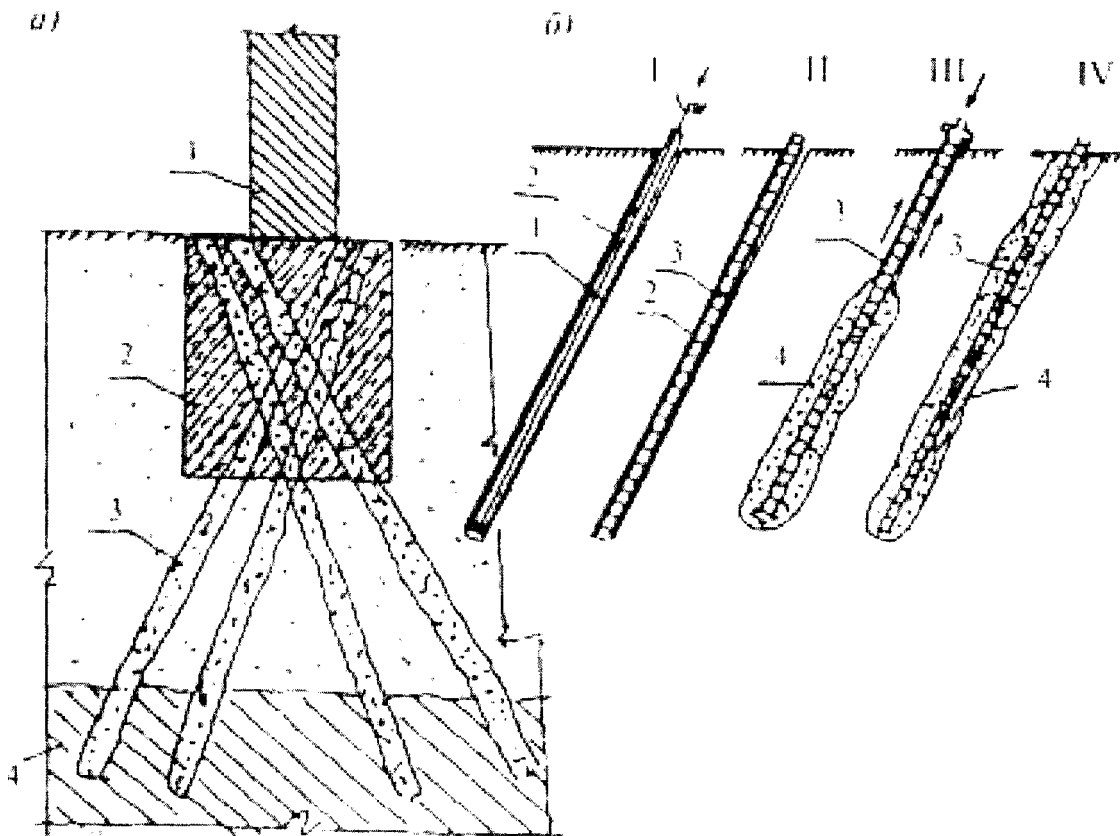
підсилення фундаментів буронабивними палями
